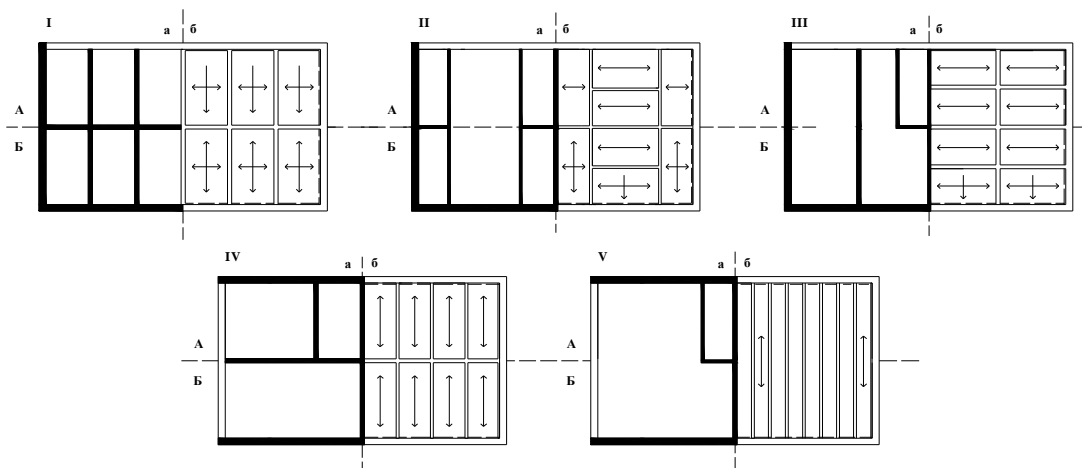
Конструктивные схемы бескаркасных зданий:
